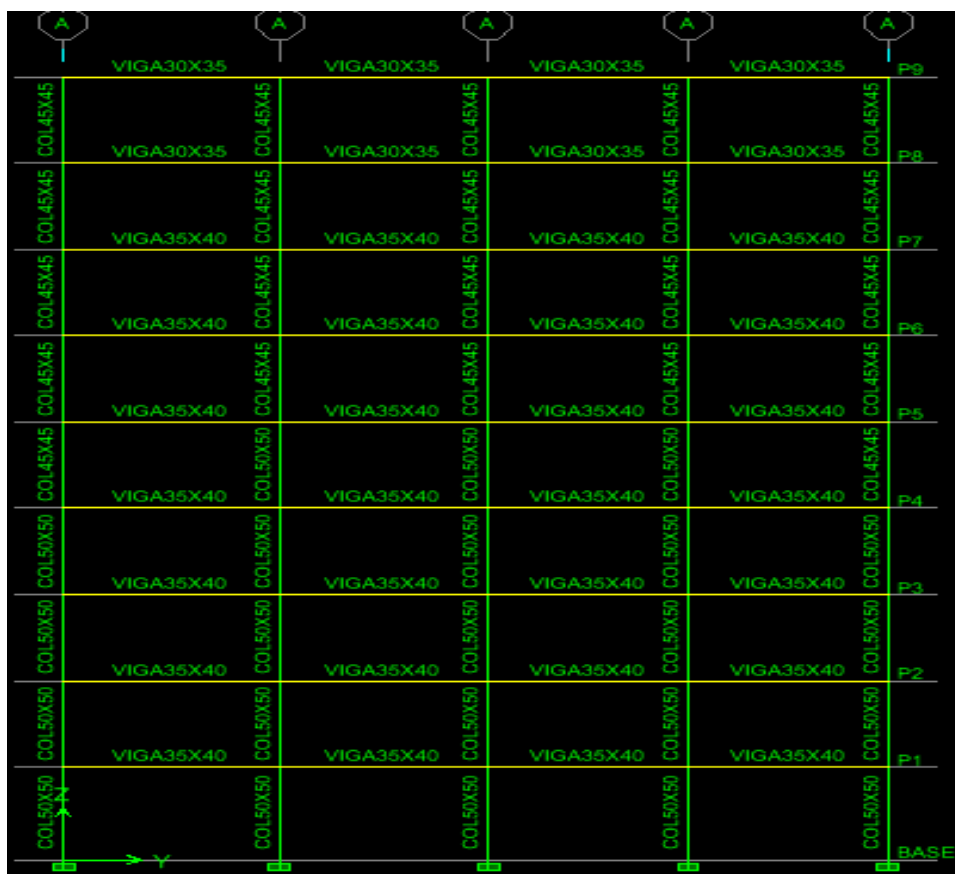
Modelo estructural con las secciones definidas Edifi. 9 Pisos
